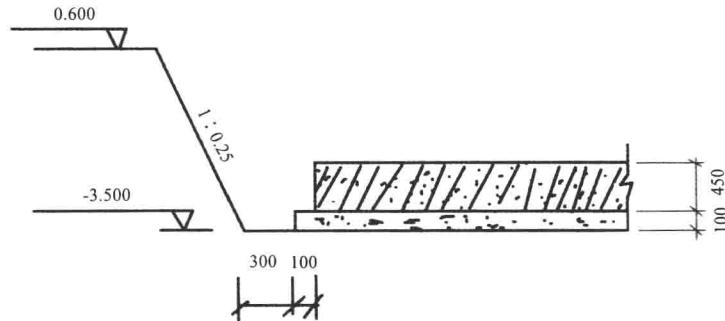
筏板基础断面图(单位:mm,标高单位:m)
